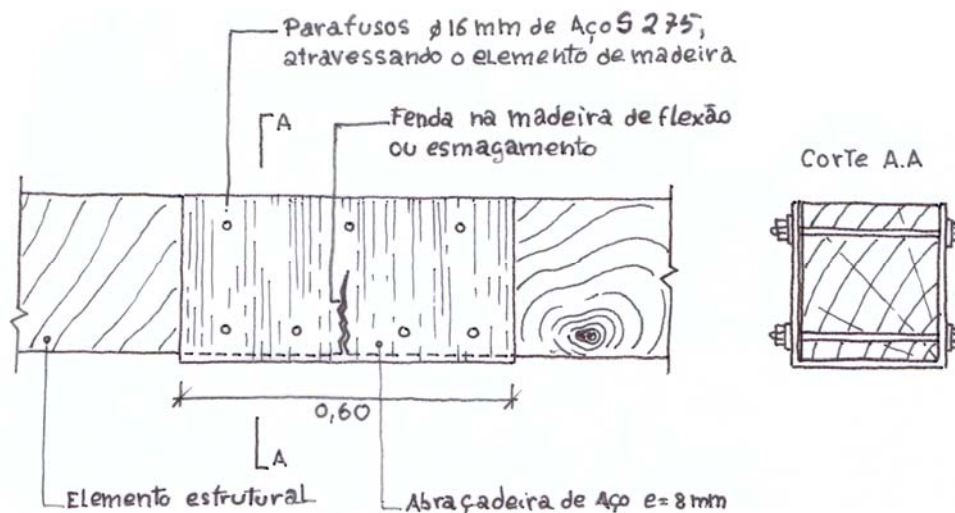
| Reforço estrutural localizado de viga ou asna, com abraçadeira de aço aparafusada
